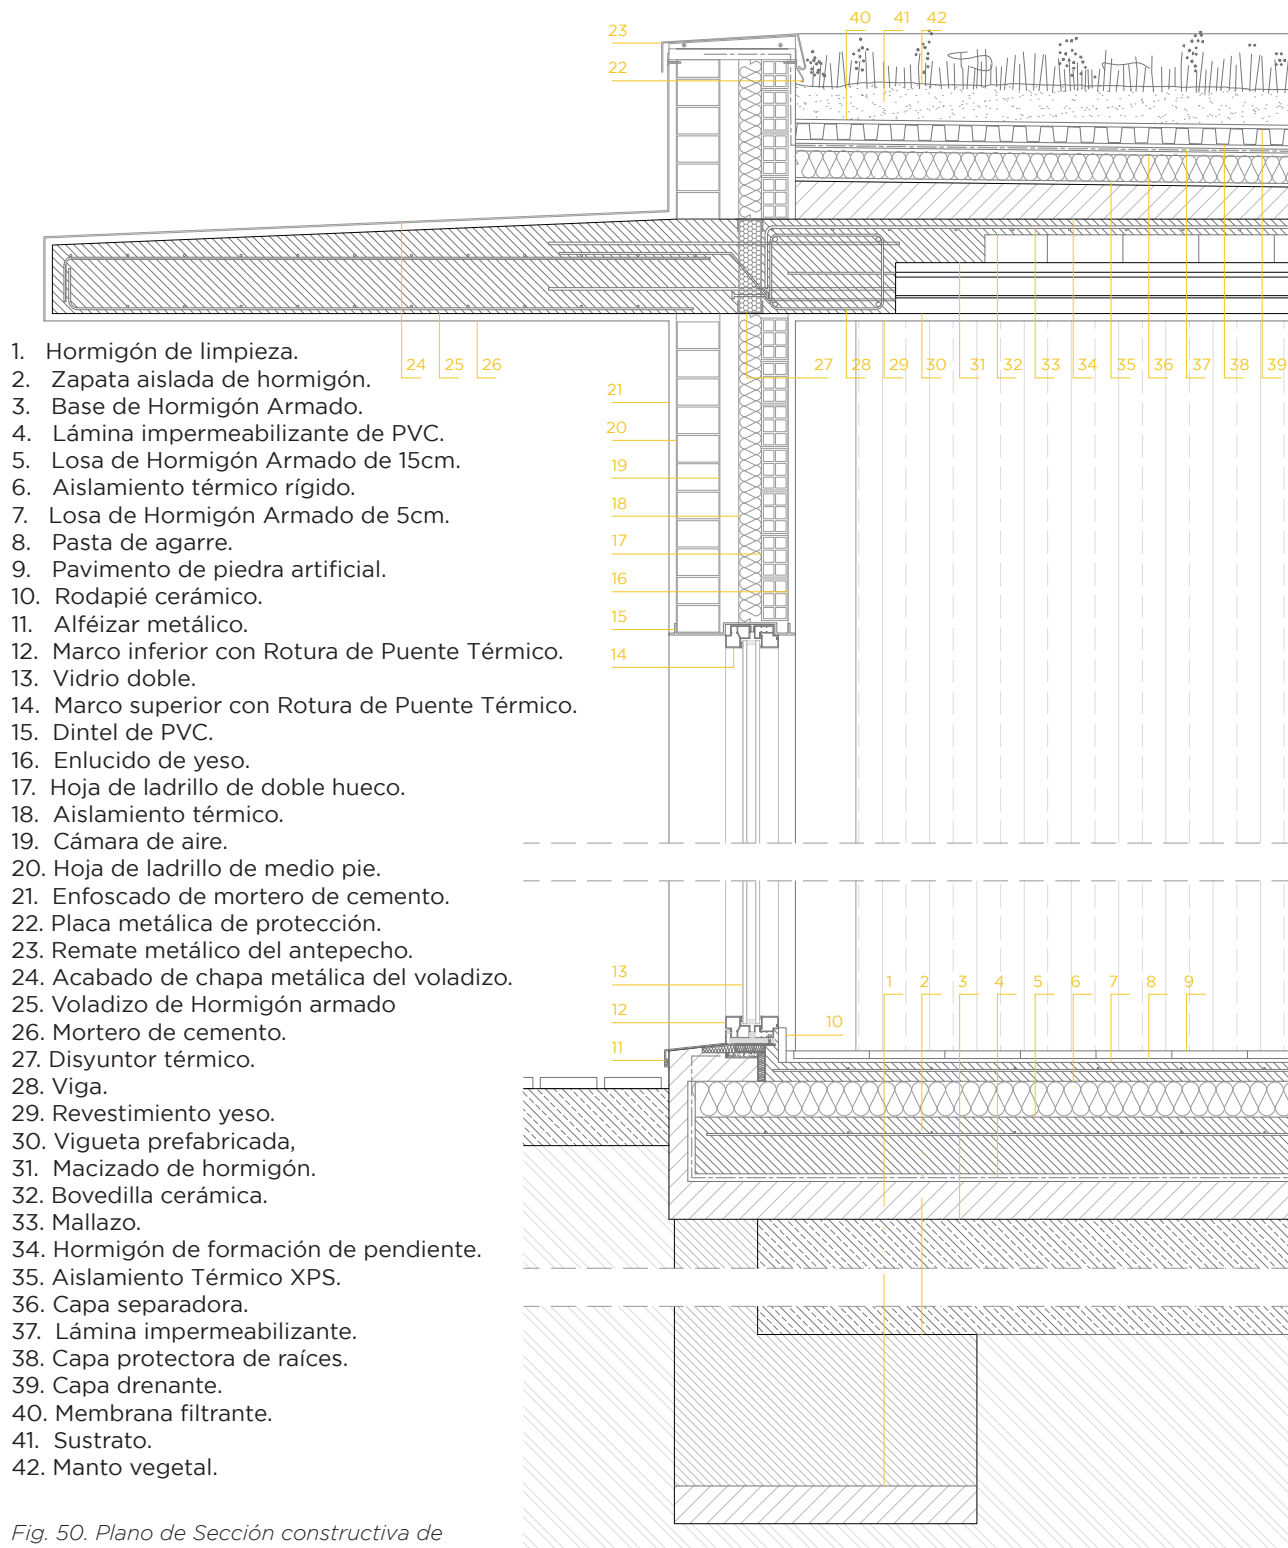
Plano de Sección constructiva de cubierta vegetal Convencional.
